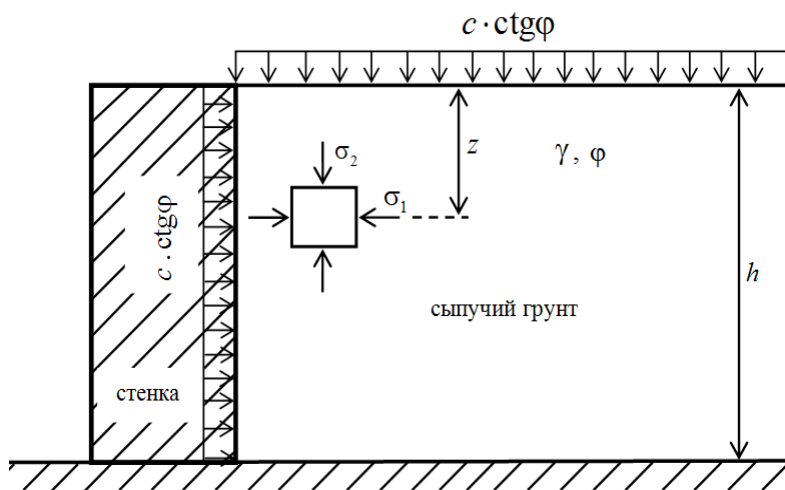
Эквивалентная расчетная схема стенки с сыпучим грунтом
